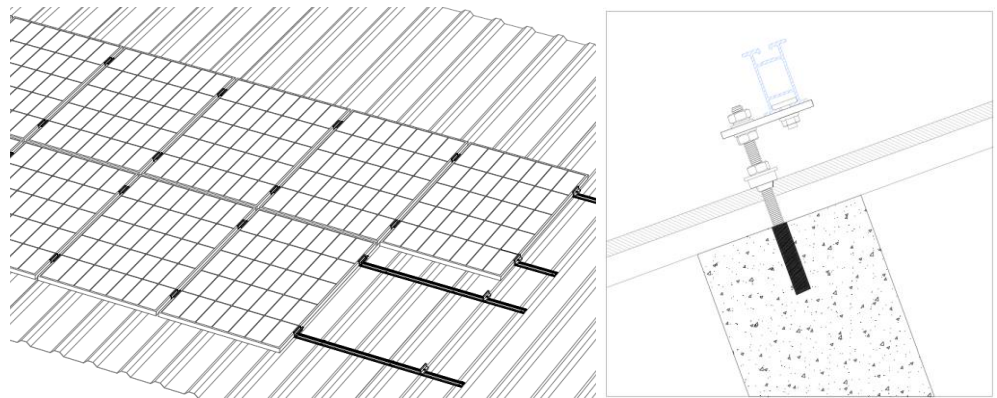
Sistema analizado / Detalle fijación a correa de hormigón
